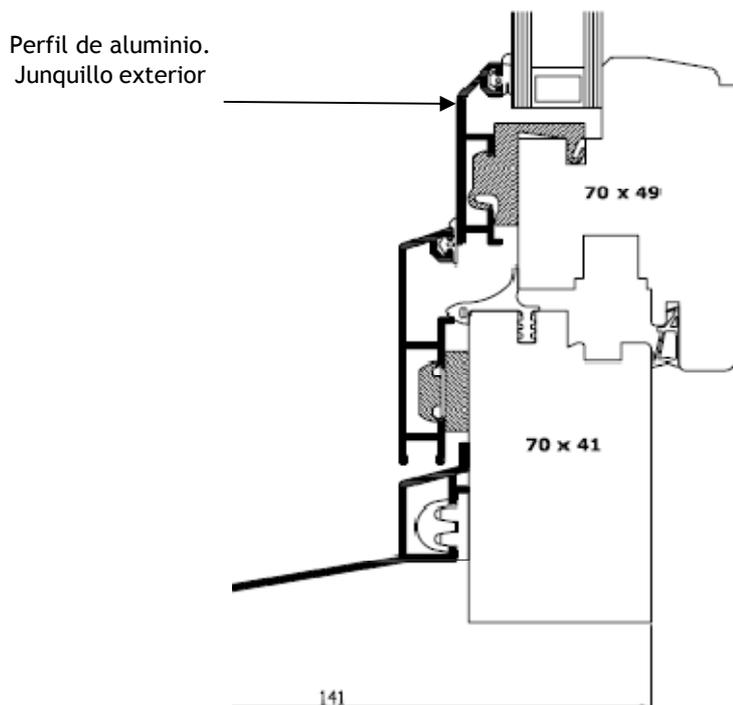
Sección longitudinal de perfil de ventana mixta de madera-aluminio. Detalle del junquillo.
